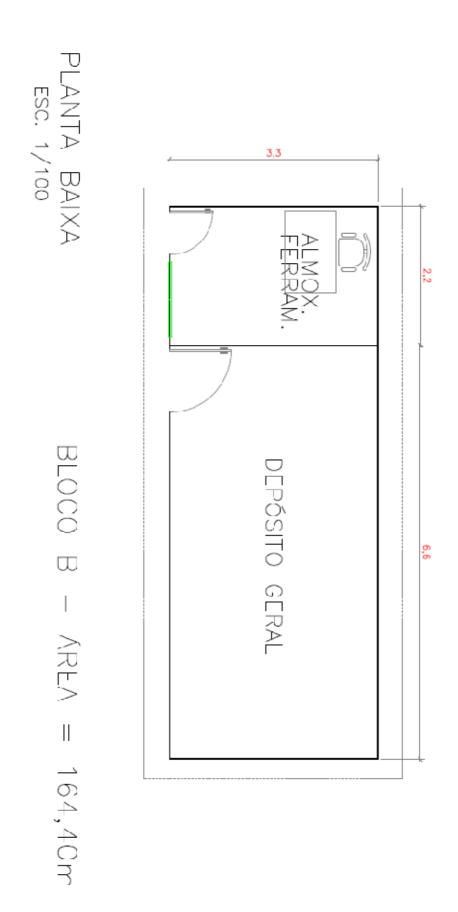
Planta baixa do segundo bloco do barração de 15 pessoas.
